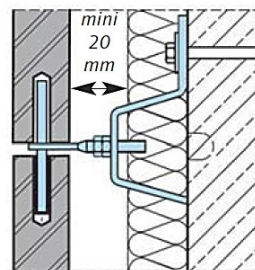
Sistema de fixação do revestimento utilizado na fachada ventilada [Halfen, 2010]
